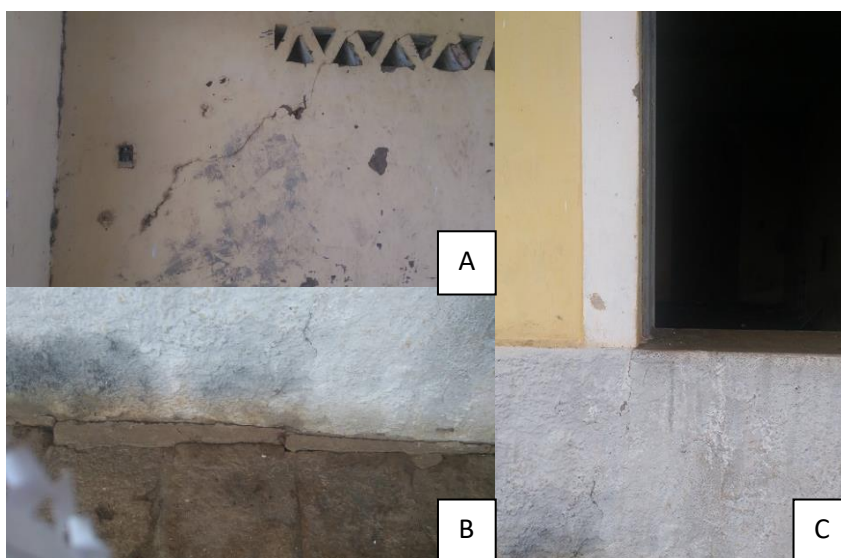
Aparecimento de fissuras (A) em parede (B) encontro do piso com parede (C) quinas com 45°
